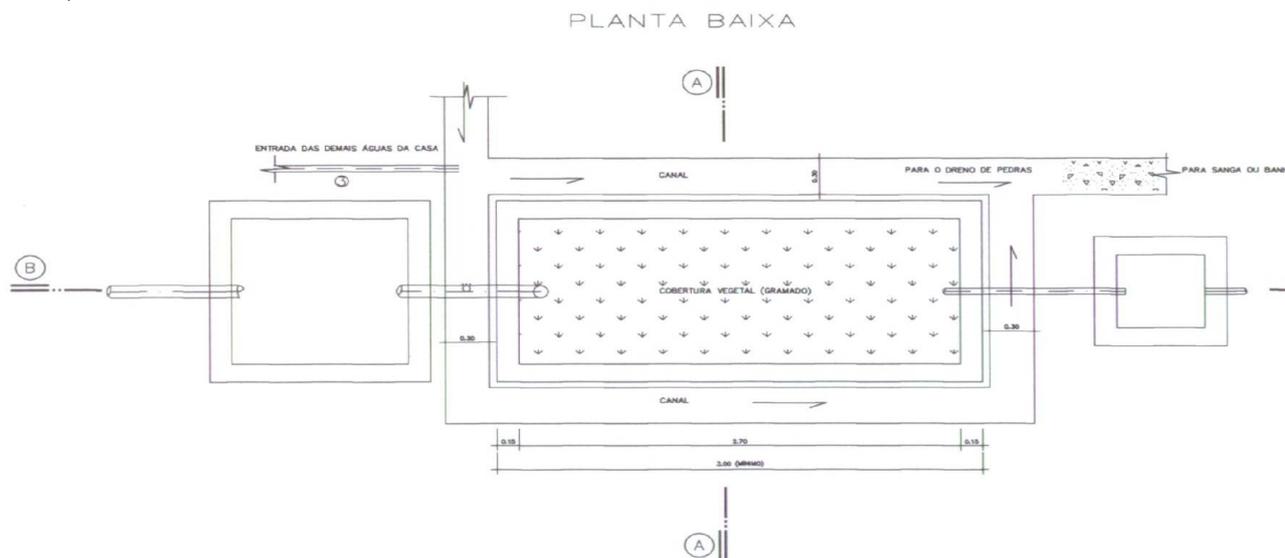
Planta Baixa do Sistema de tratamento de Efluentes Caseiros
